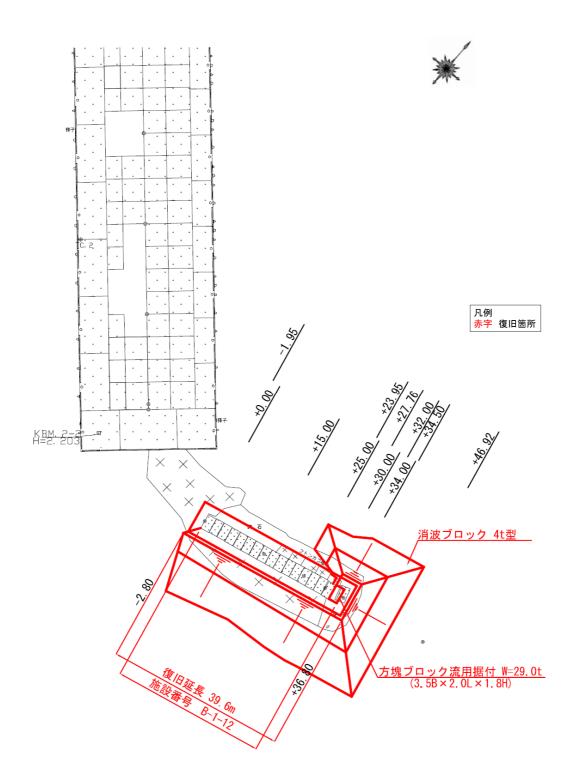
No.2 半崎地区_波除堤平面図(復旧後)
